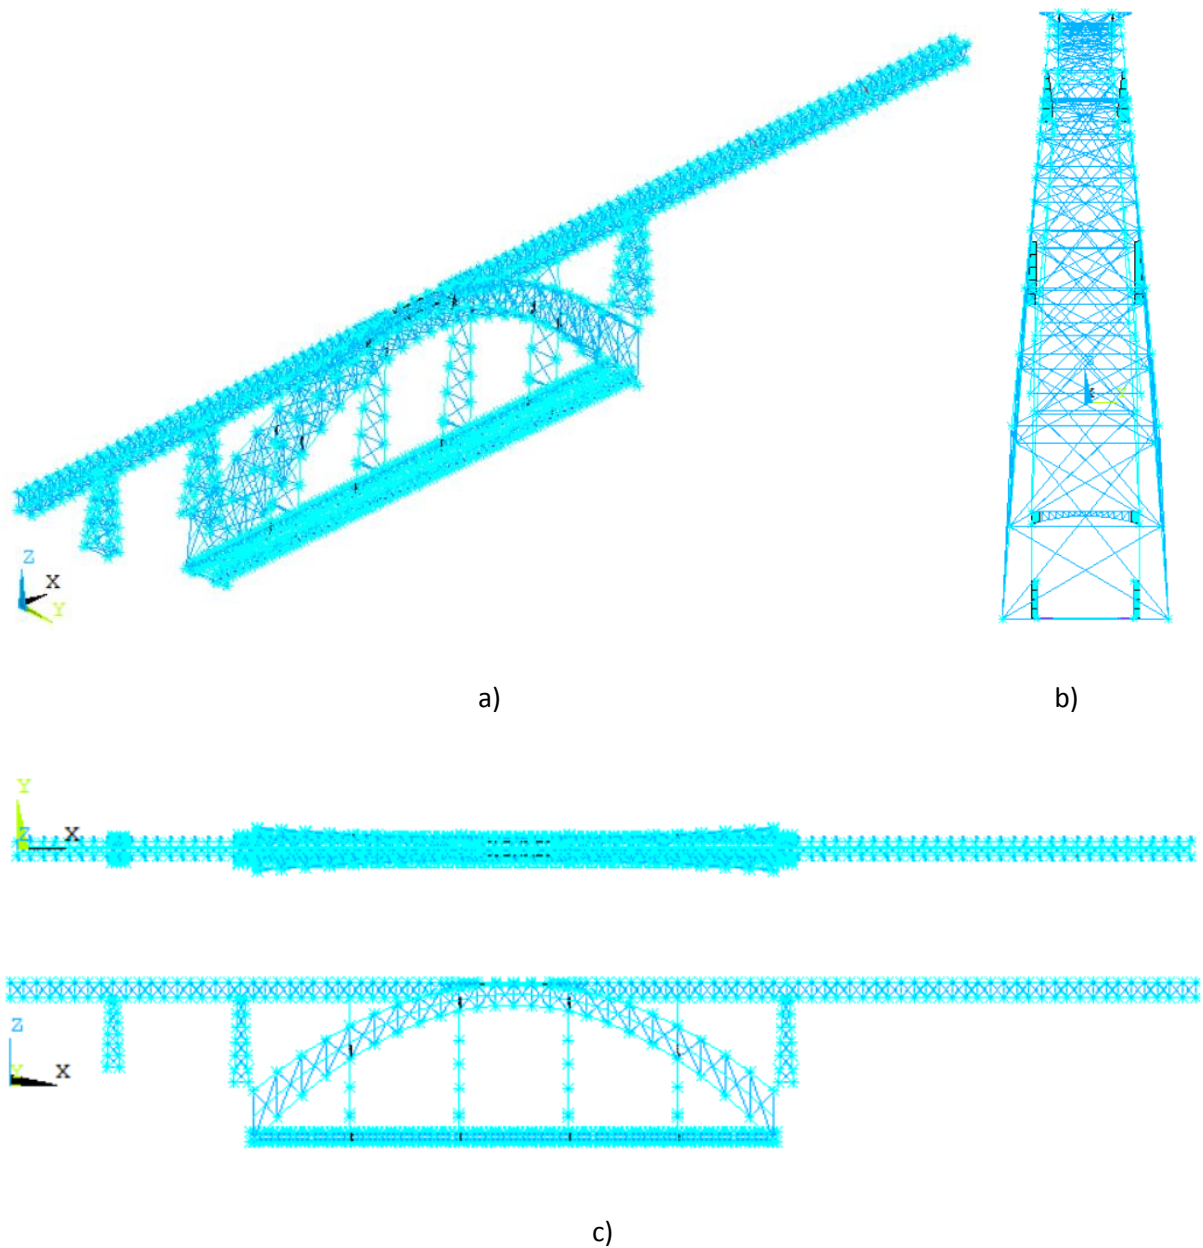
Modelo 3D da ponte, Perspetiva (a) alçado (b) e plantas (c).
